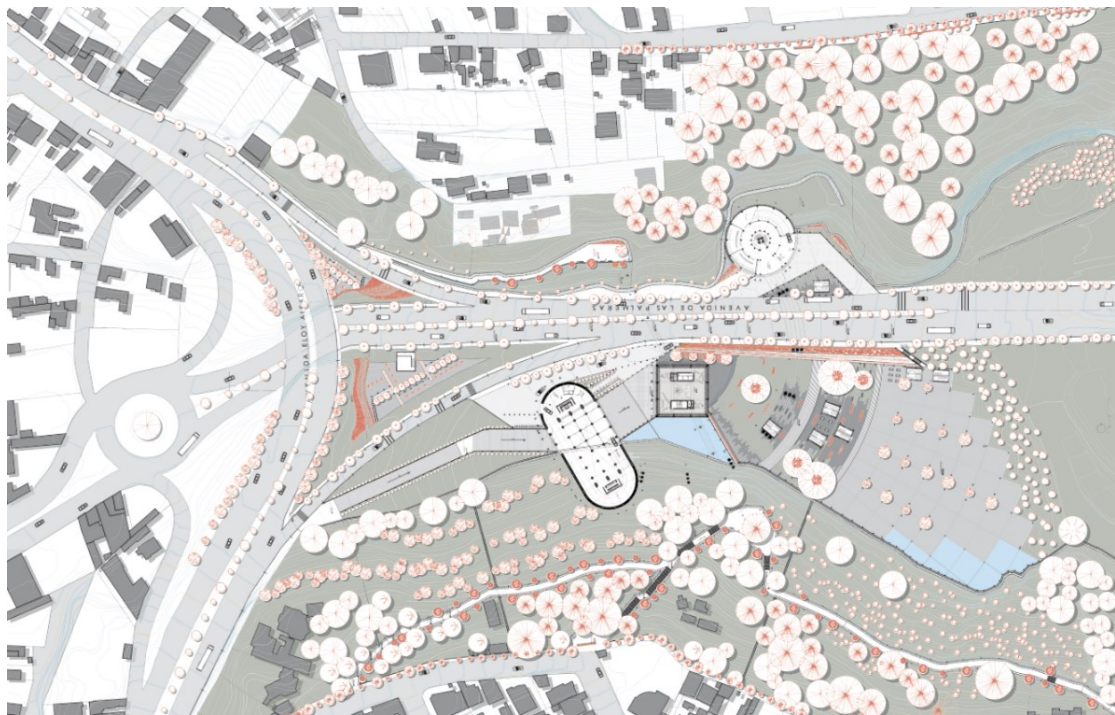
Planta baja a nivel paisajístico (Buenaño, 2020)
